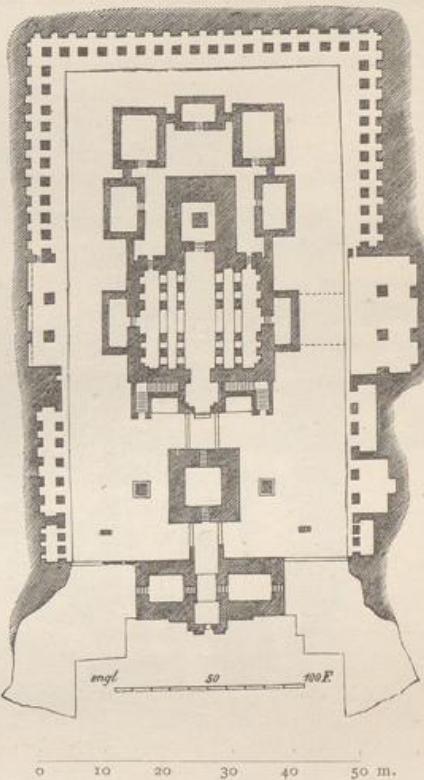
Kailasa zu Ellora. Grundriss.
